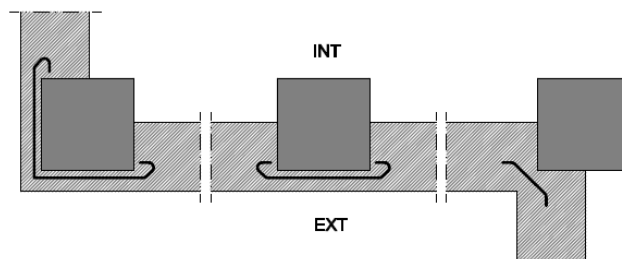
Ejemplo de encuentro de la fachada con los pilares
